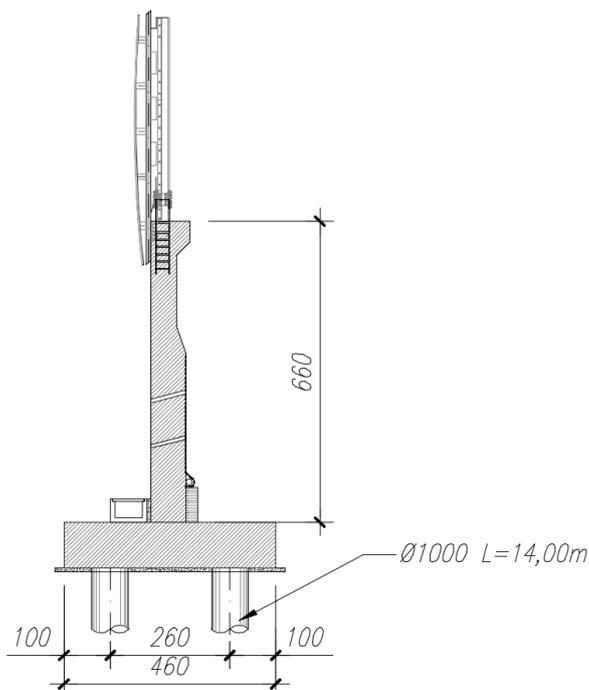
Muro di scavalco in c.a. su fondazioni profonde – Sezione tipo
